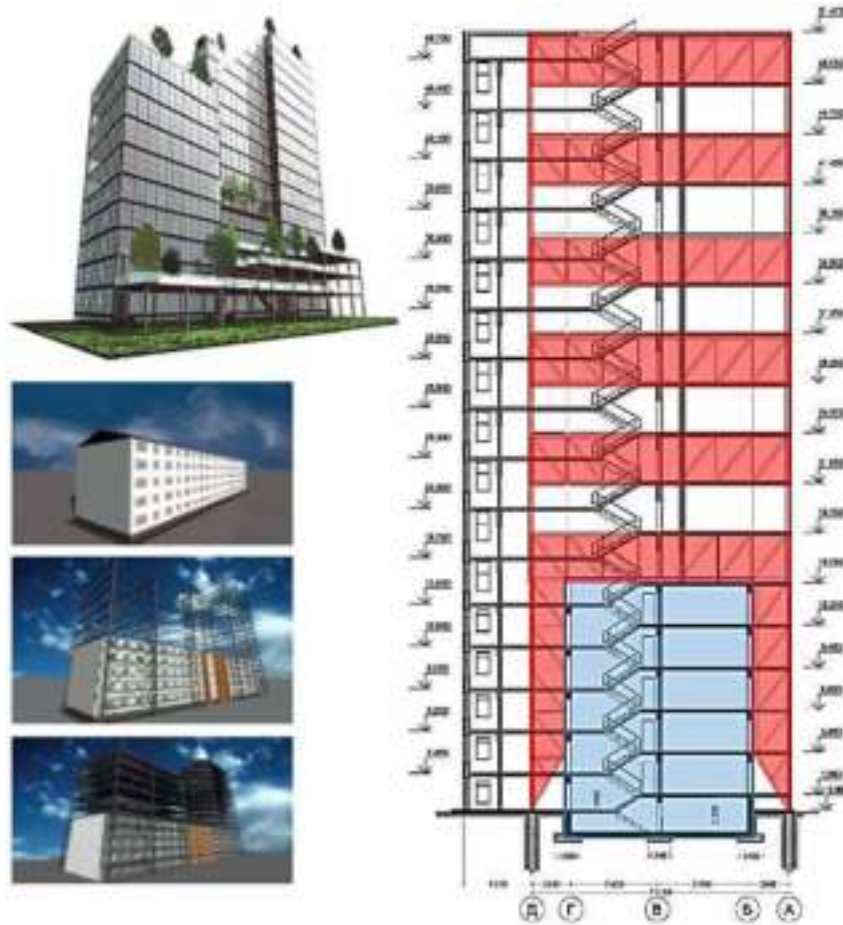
Проект реконструкції 5-поверхового житлового будинку методом надбудов
